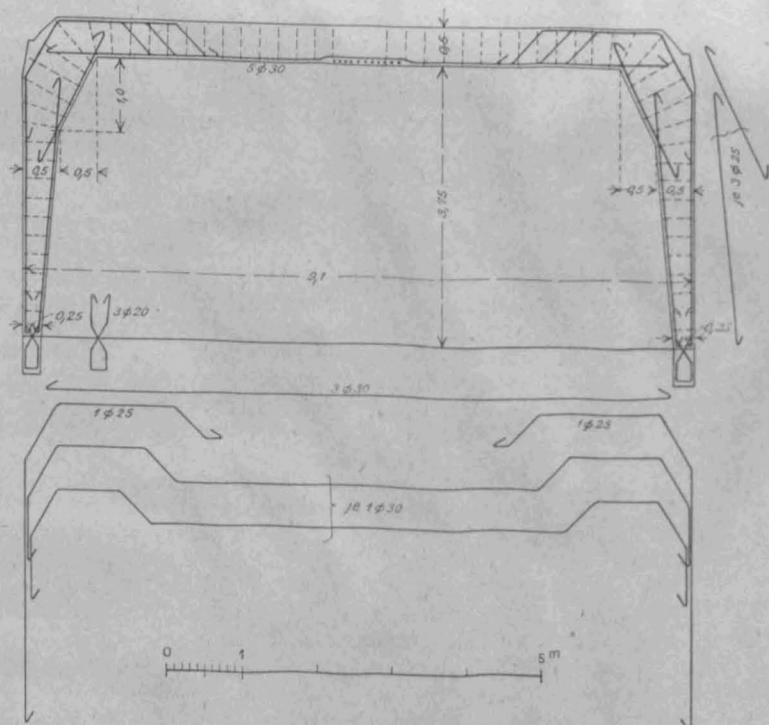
Rahmen-Konstruktion der Dachbinder.
